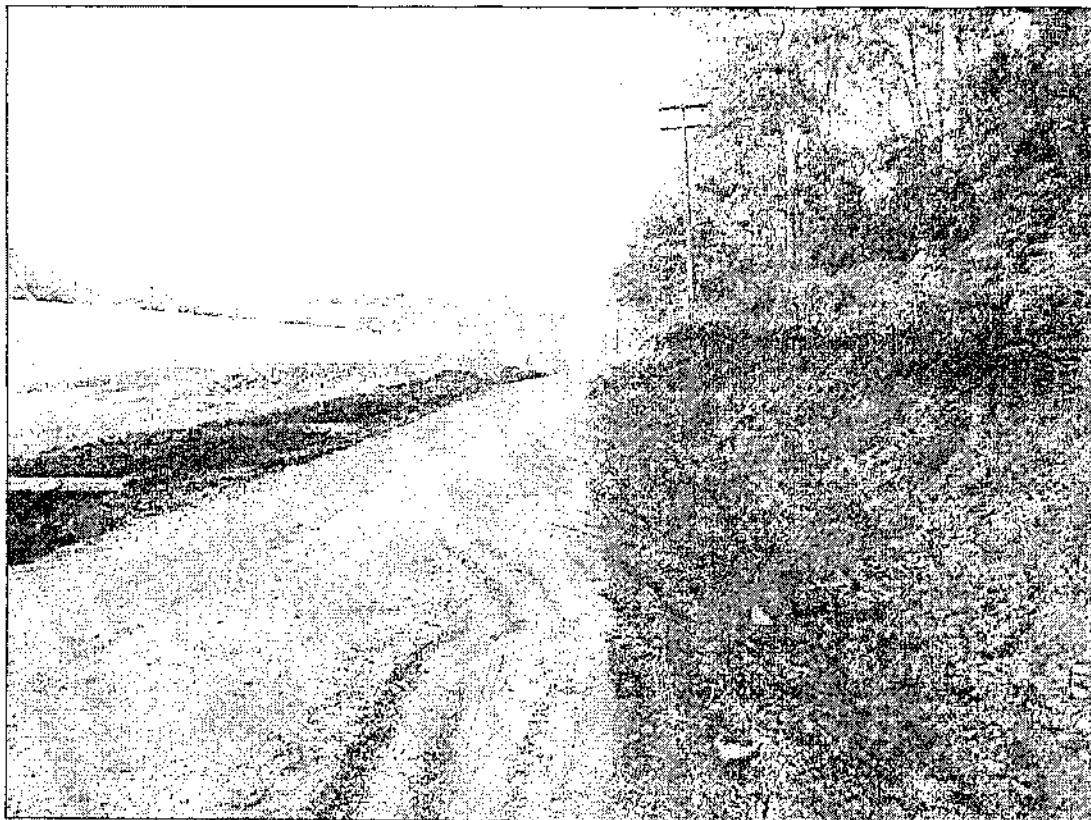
Escavação para alargamento próximo da estaca 184.
